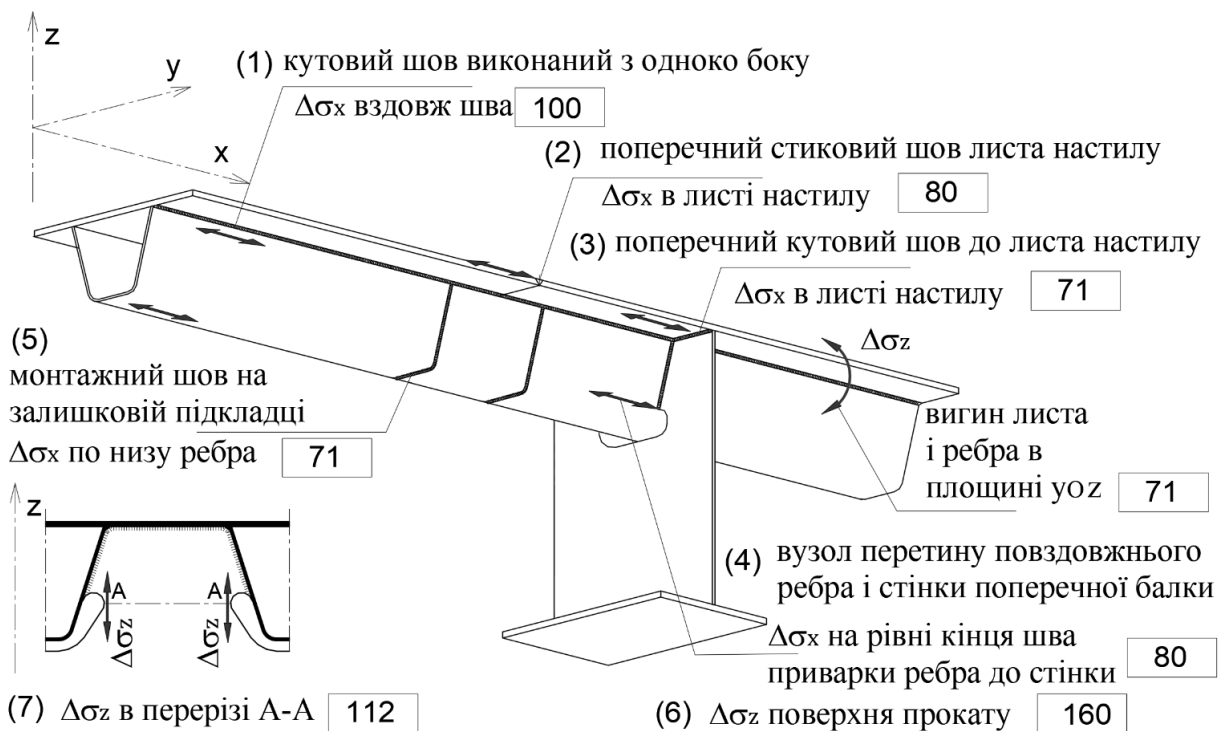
Вузол перетину поздовжнього ребра і стінки поперечної балки
